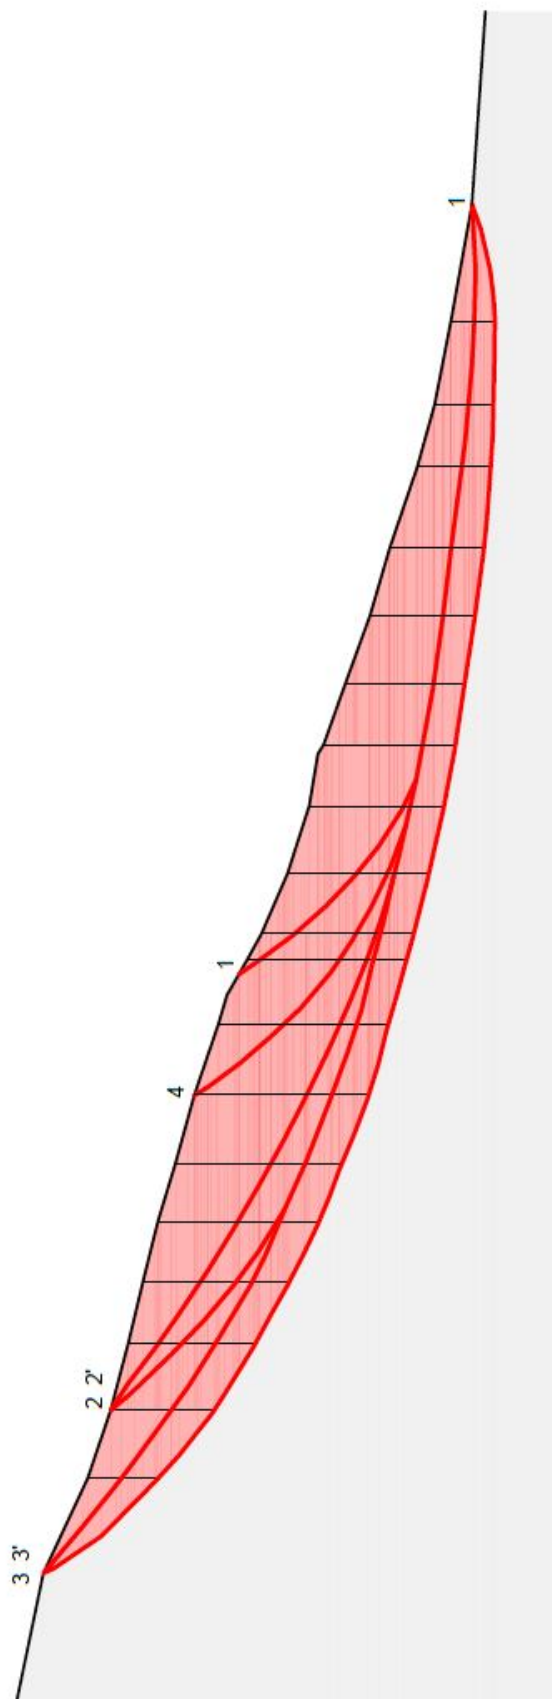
Schema de calcul pentru determinarea stabilității versantului pe terenul nr.5 „Valea trandafirilor”, mun. Chișinău
